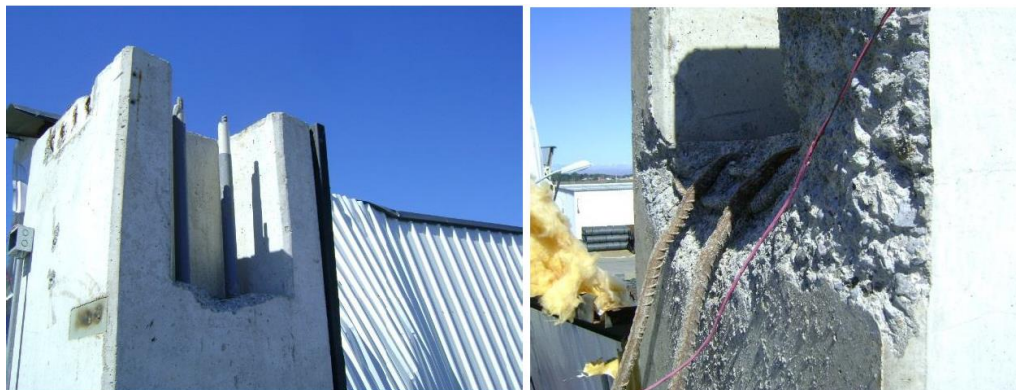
Falla de conexión viga – pilar con conexión tipo pasador.
